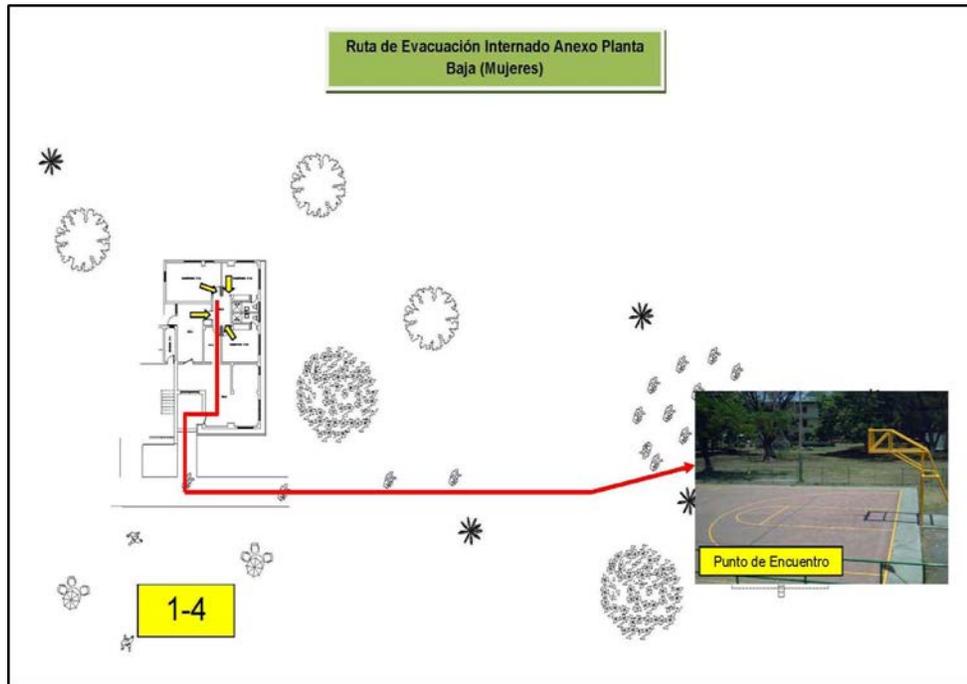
Ruta de Evacuación del edificio del Internado (anexo planta baja)
